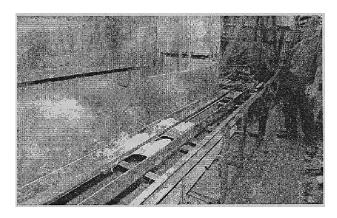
Электротермическое натяжение арматуры и формирование порошкового покрытия на арматуре
